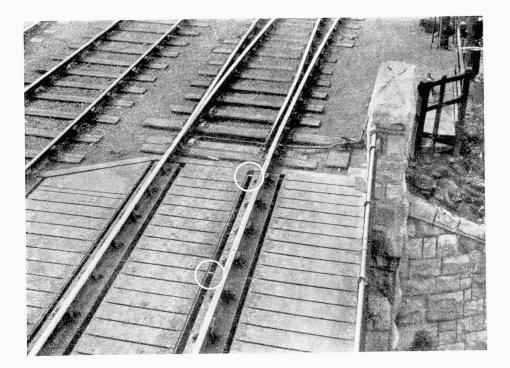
Brückenende und Weiche. Lage der Risse. Extrémité du pont et aiguille. Emplacement des fissures. Bridge end and switch. Position of fractures.
